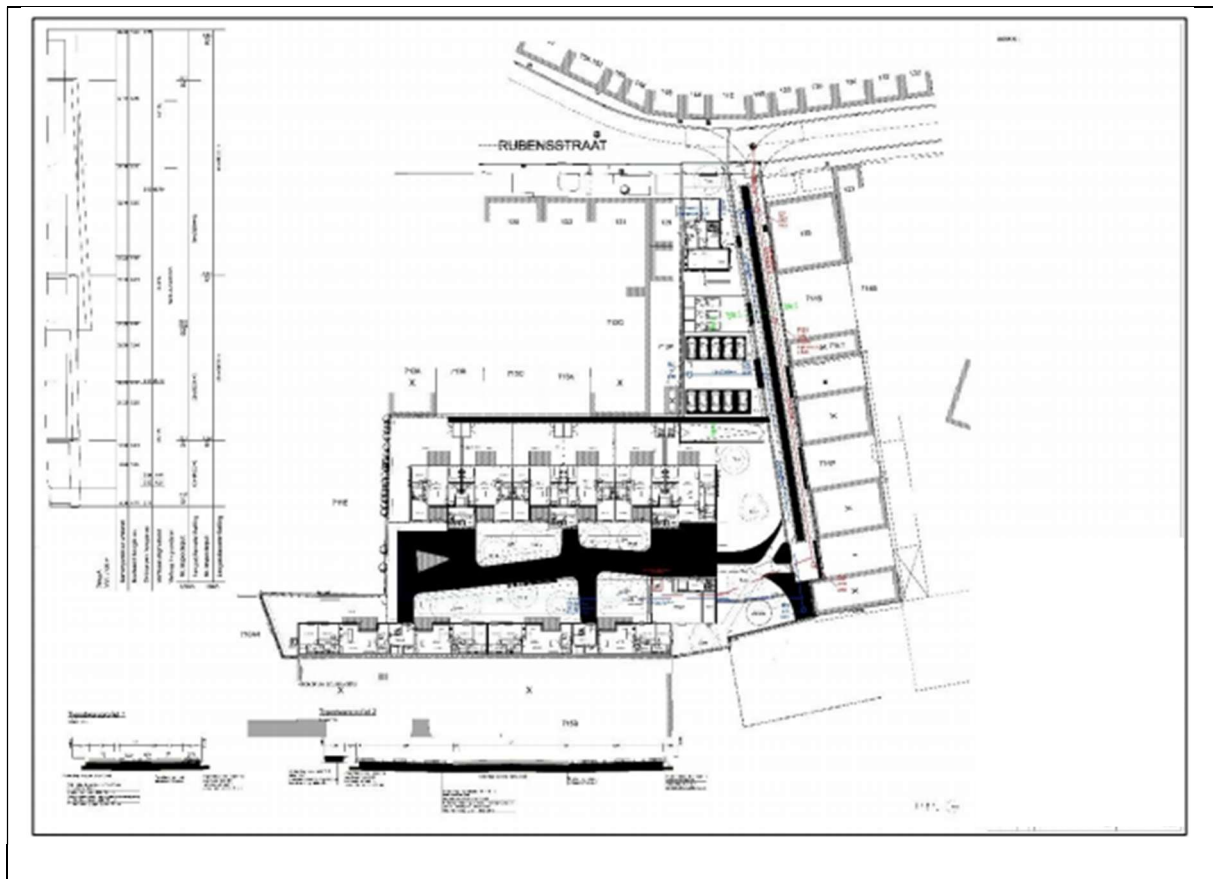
Bouwplan zuidelijke zone (overdracht naar openbaar domein).
